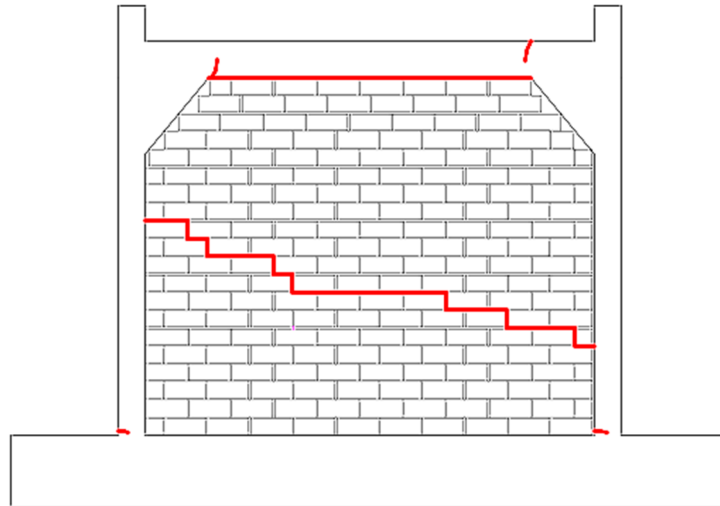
25: Expérimental : Micro fissures aux pieds des poteaux, Micro fissures aux extrémités de la poutre supérieure, Fissure de séparation de la partie supérieure du panneau et de la poutre, Fissure horizontale en escalier au milieu du panneau. ($\delta= 1.60$ mm, drift =0.08%).
